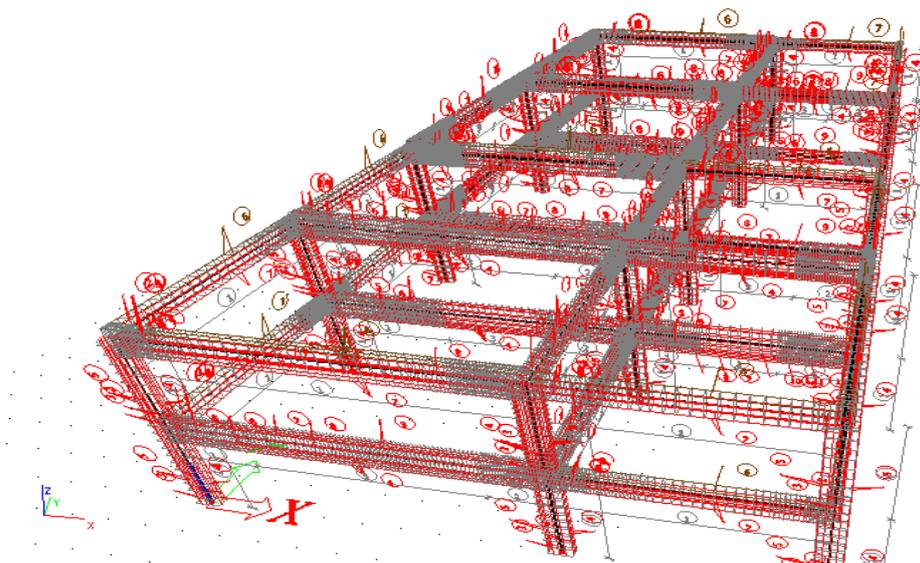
Estrutura de concreto – Armadura total da estrutura
